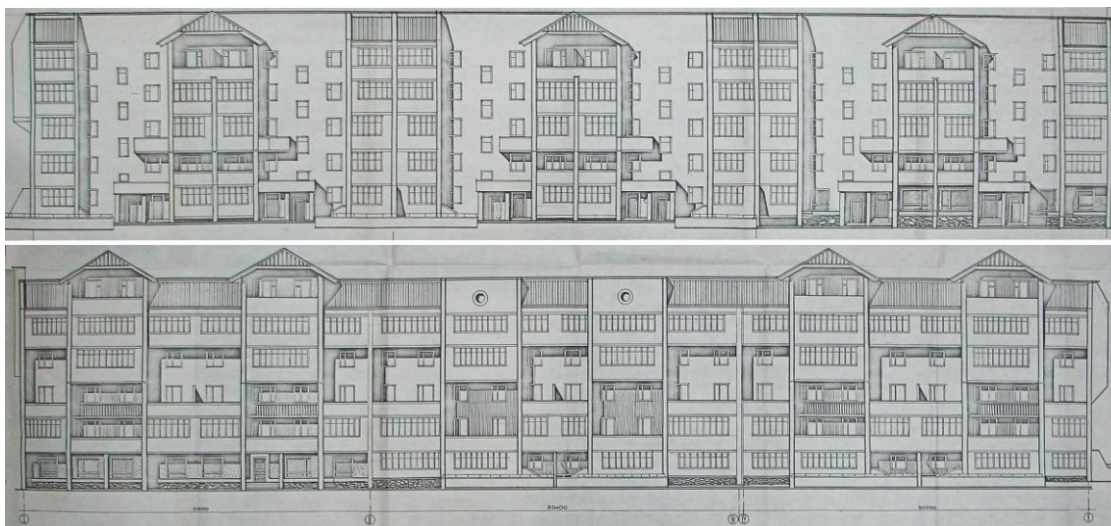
Чертежи дворового и уличного фасадов. Жилой дом по ул. 9 Мая, д.
